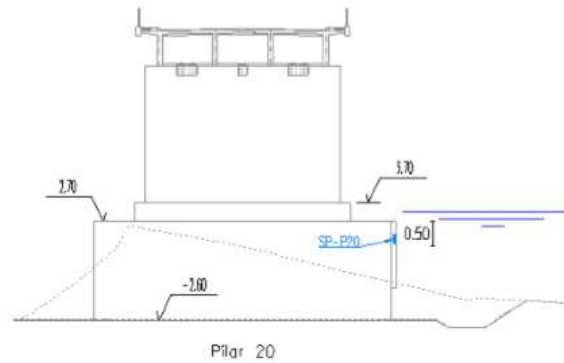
Instalação do sensor de pressão junto ao pilar P20.
